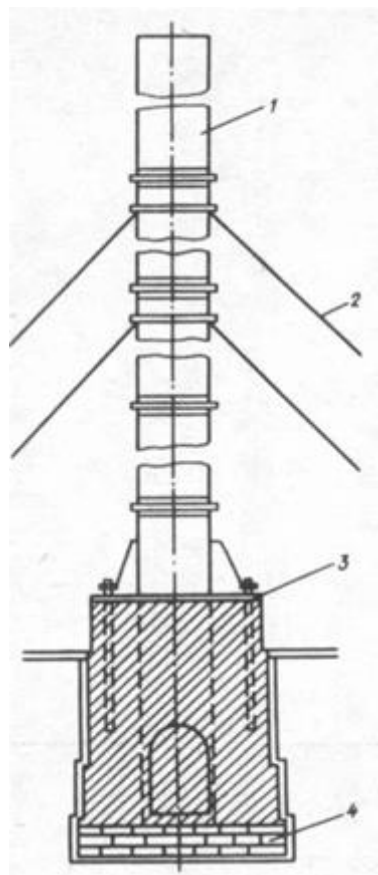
Стальная дымовая труба. 1 – ствол трубы; 2 – растяжки; 3 – чугунная плита; 4 – фундамент.
